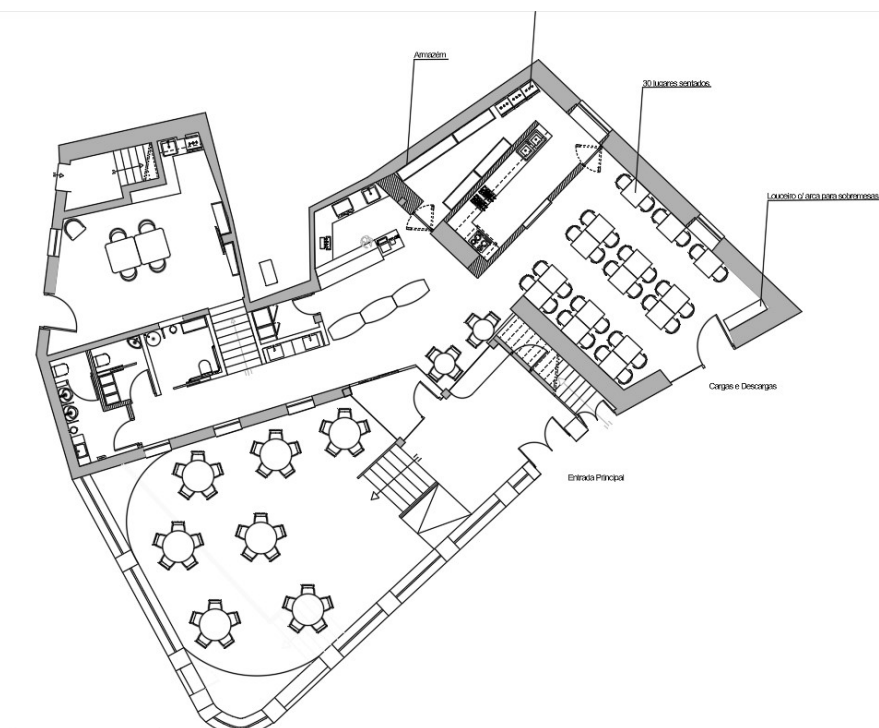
Plantas de estudo de equipamento. Fonte: o Autor.
